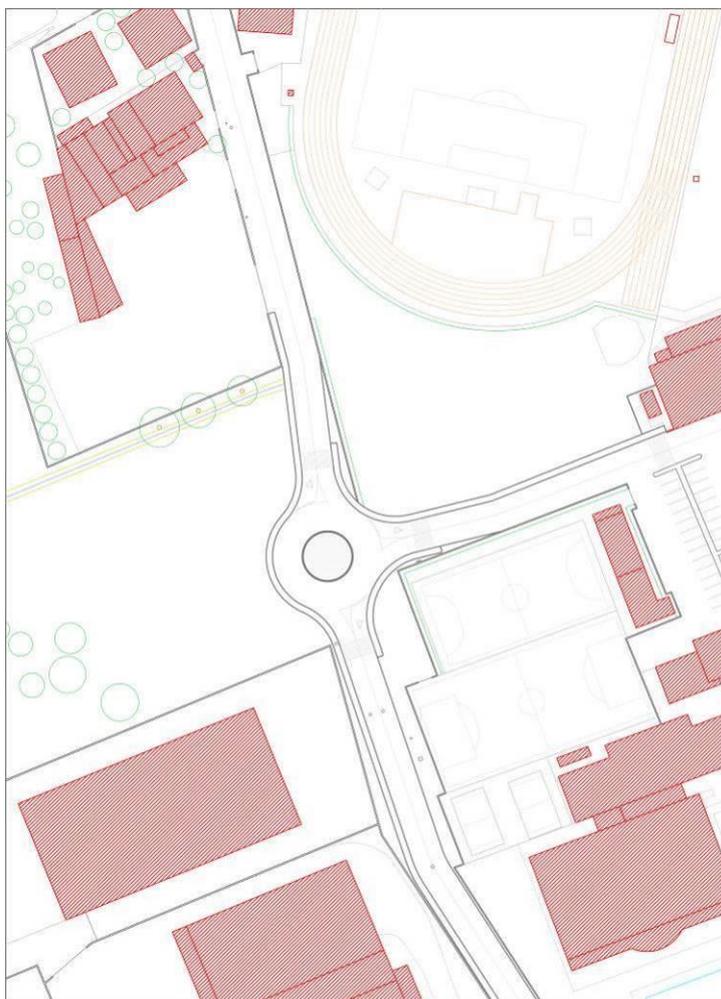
Ipotesi futura di realizzazione della rotonda e della nuova viabilità
